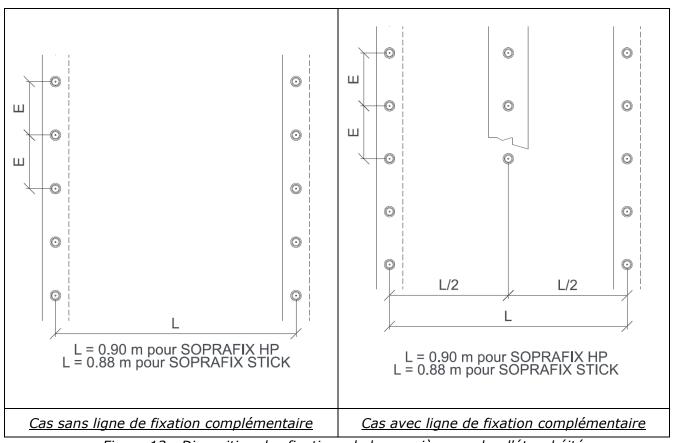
Disposition des fixations de la première couche d'étanchéité
